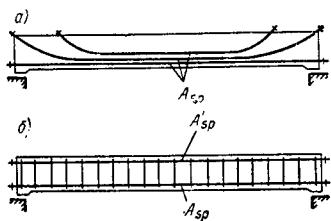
Примеры размещения арматуры в растянутой зоне поперечного сечения предварительно напряженных балок
